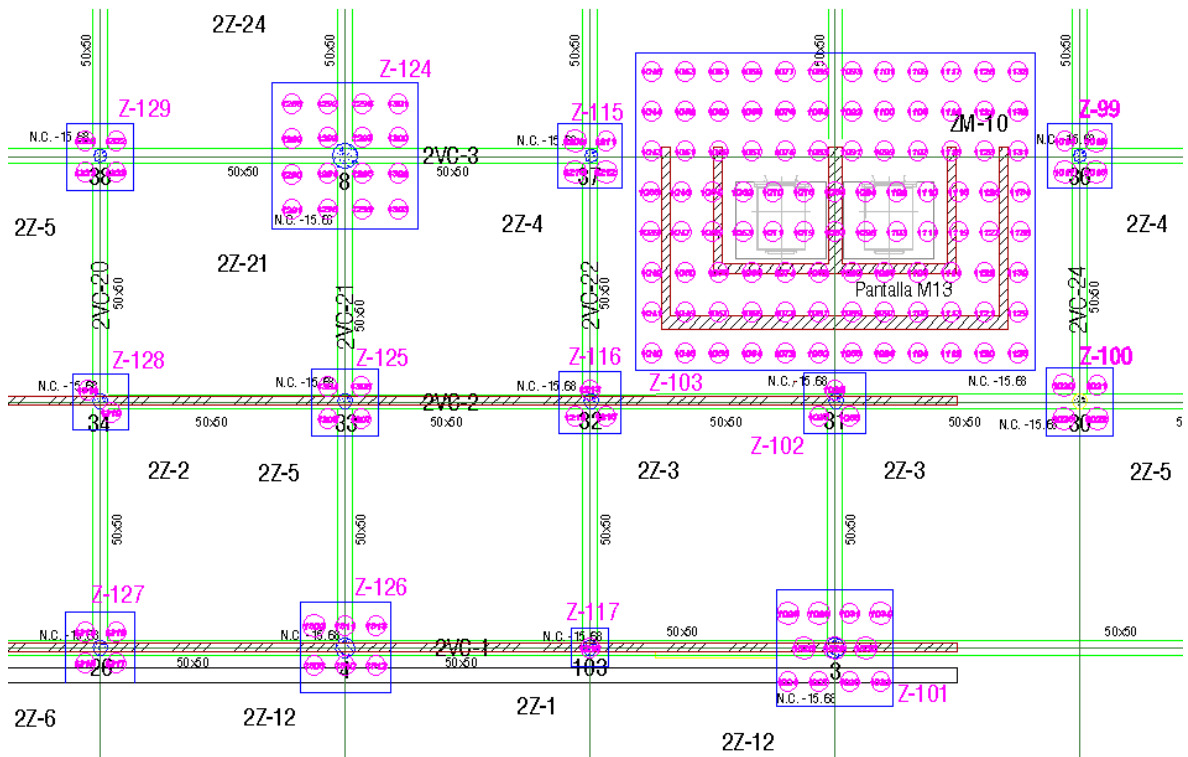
Plano de puntos de geopier. Fuente Centra Ingeniería y construcción SA.
